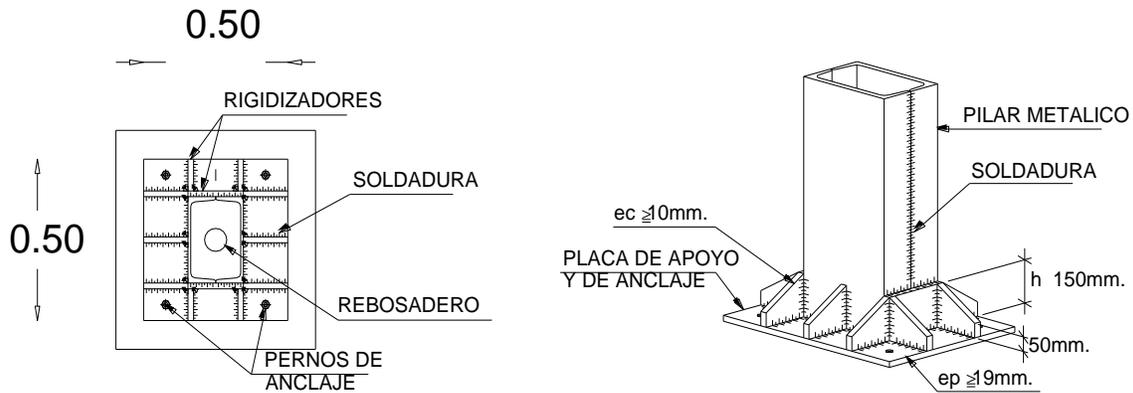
Corte vista planta e isométrico de la unión entre zapata y columna.
